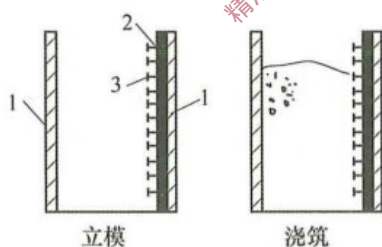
先装填料后浇筑混凝土的填料施工
